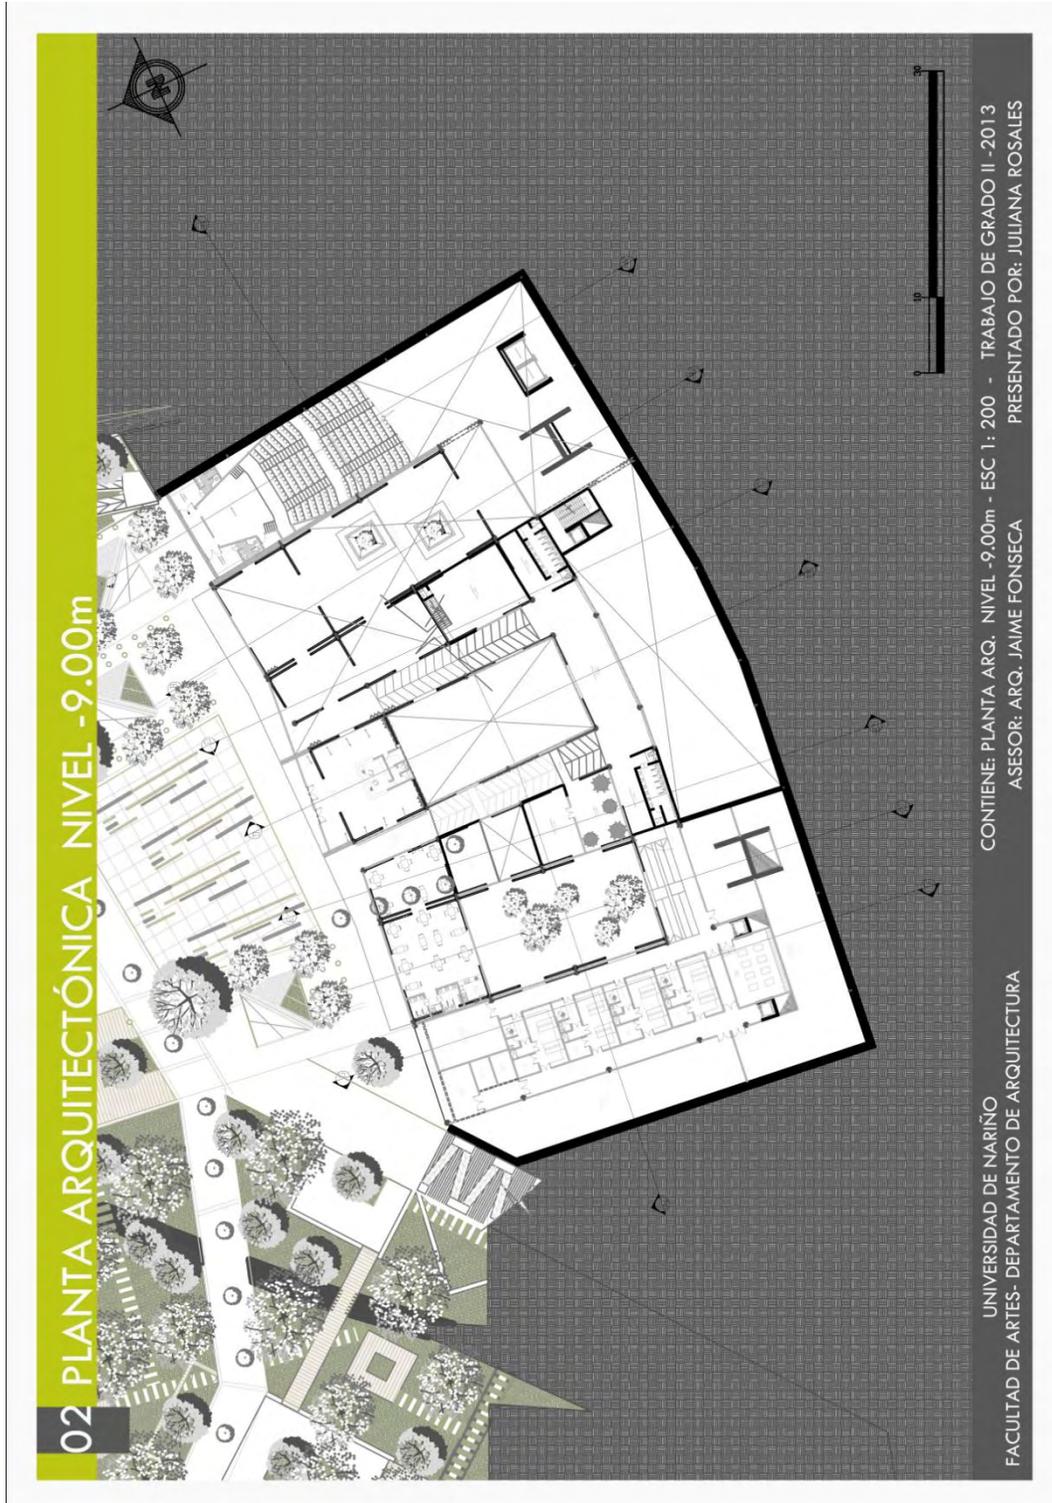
Proyecto_ Planta nivel -9.00m // Fuente esta investigación
